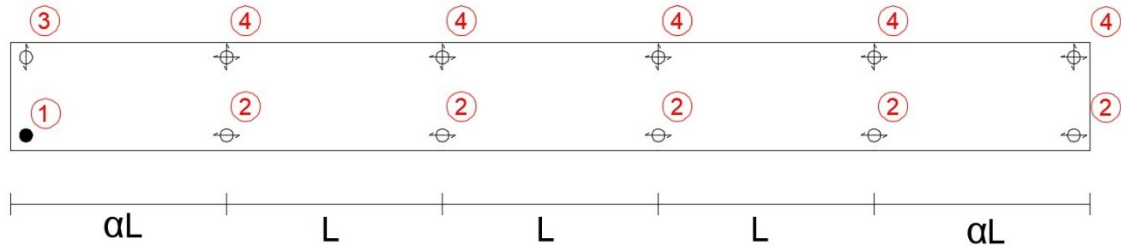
Disposizione planimetrica dei dispositivi di appoggio.
